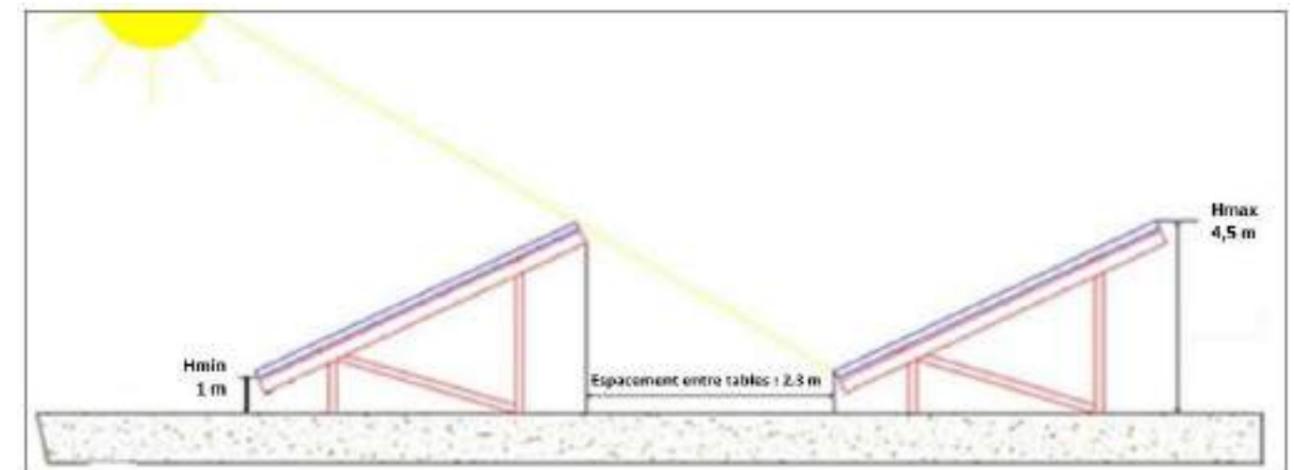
Détail des hauteurs et espacements entre tables (Source : TSE)
